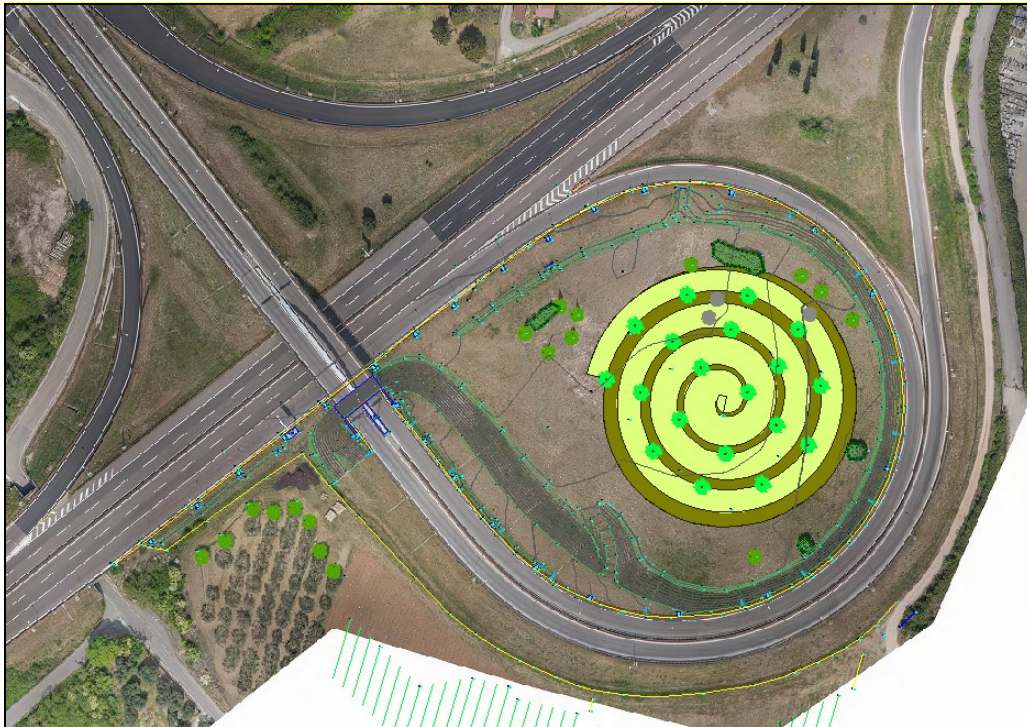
Estratto planimetrico con localizzazione dell'intervento e sezione tipologica da Nord verso Sud (stralcio tavole INTERVENTI DI RIMODELLAZIONE CON SISTEMAZIONE AMBIENTALE, allegate al progetto)
